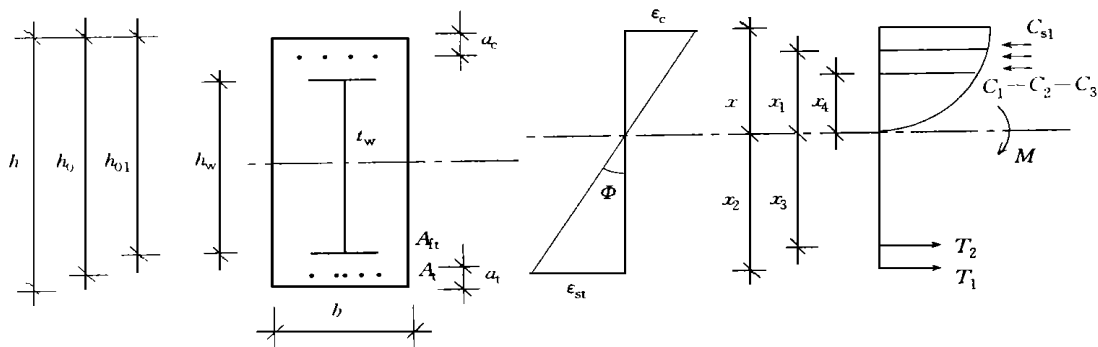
劲性钢筋混凝土截面的尺寸及应变和内力
